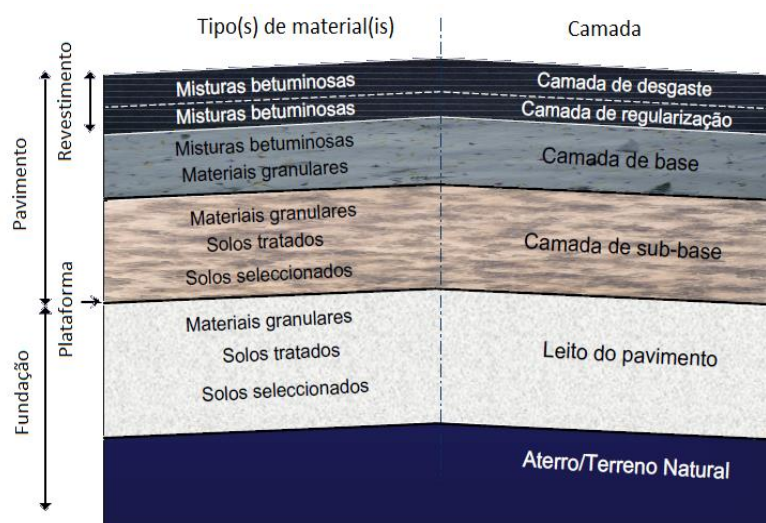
9: Corte esquemático de um pavimento flexível (Antunes et al, 2006)
